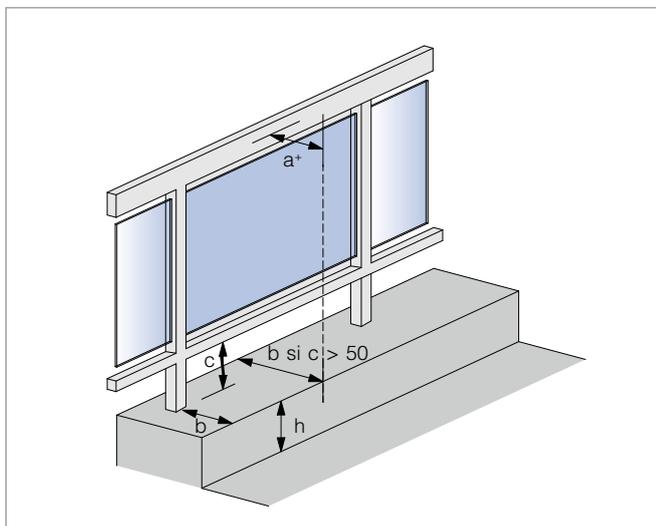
Zones de Stationnement : paramètres déterminants (mm).
